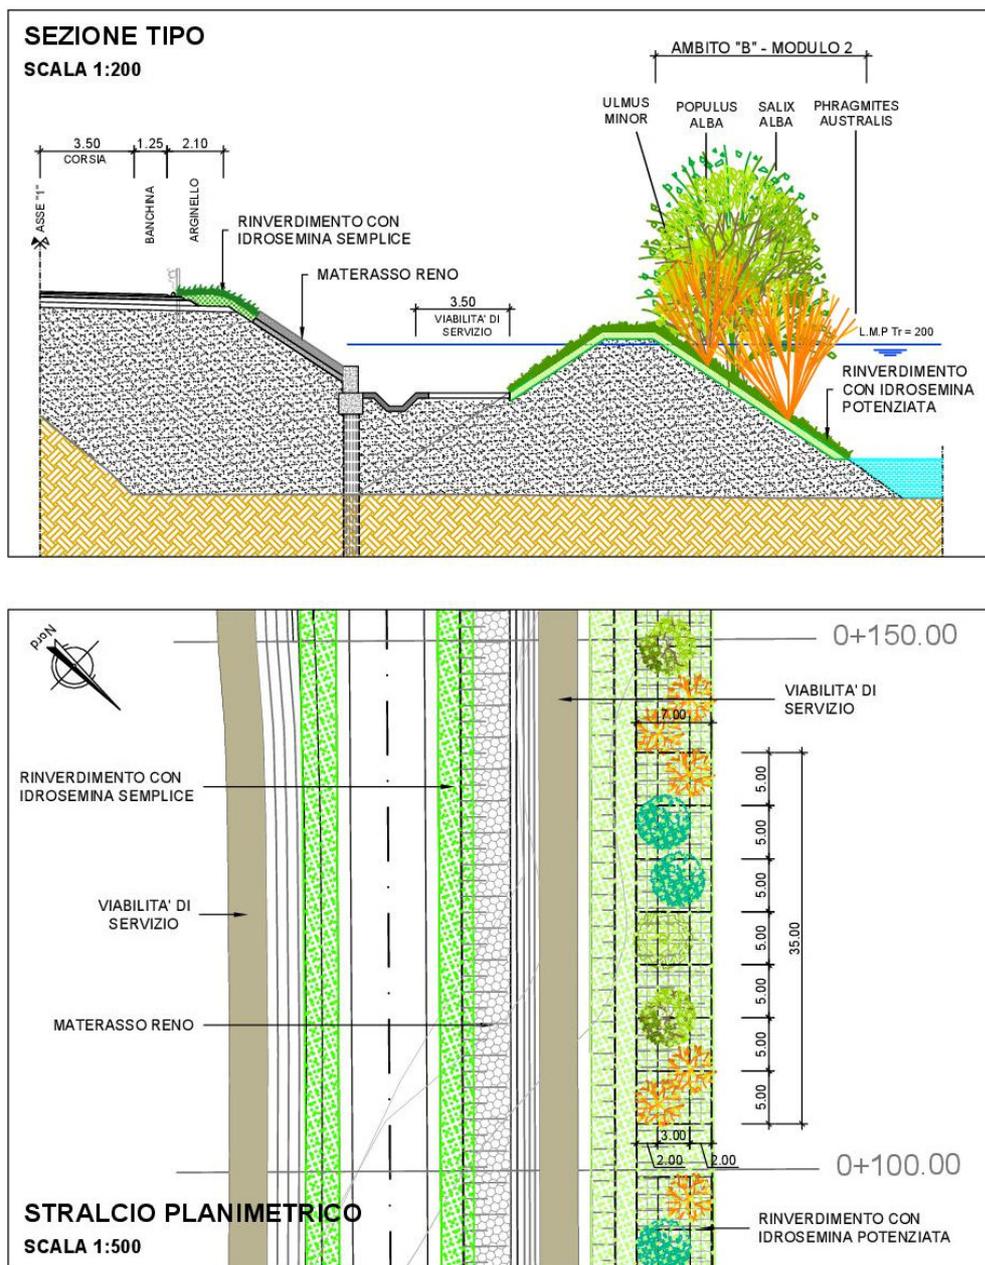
Stralcio planimetrico e sezione - Ambito B, Modulo 2 – Lato Tevere
